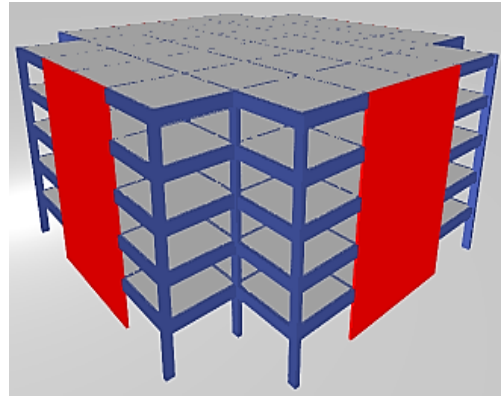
Kolon ve kiriş kesitlerinin tanımlanması
